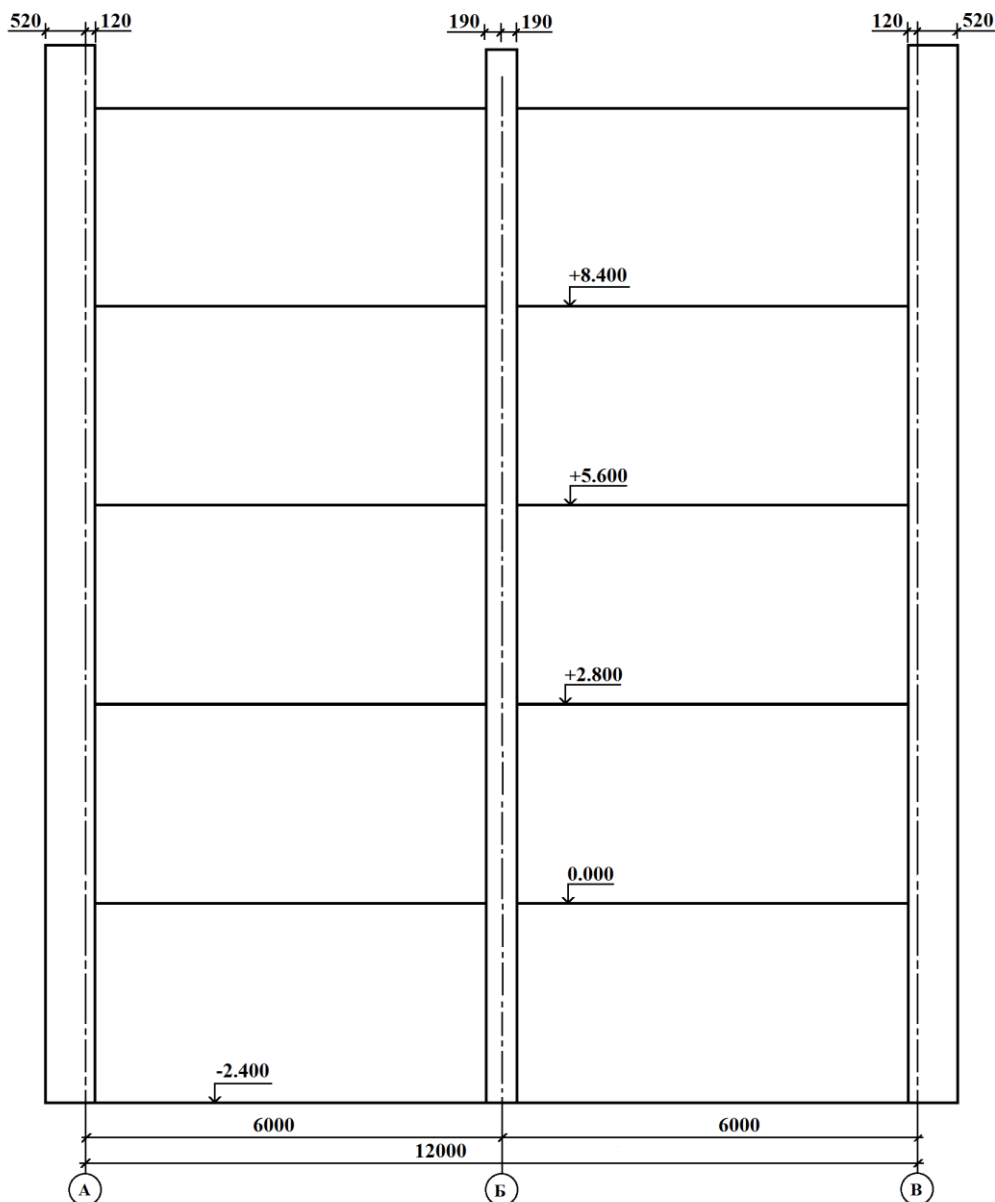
Разбивка здания на этажи и привязка стен к осям
